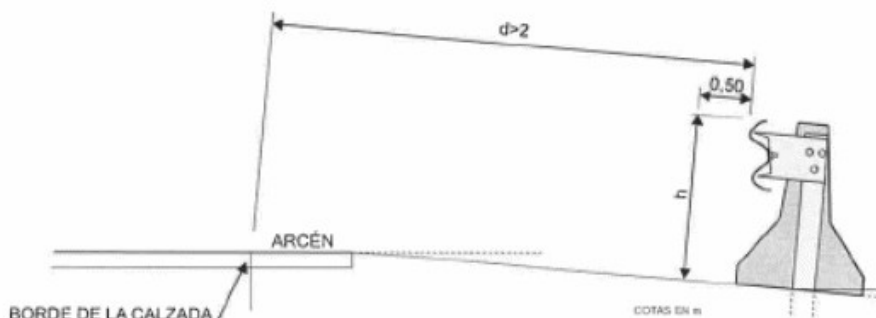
DISPOSICIÓN EN ALTURA DE LAS BARRERAS DE SEGURIDAD SITUADAS A MÁS DE 2m DEL BORDE DE LA CALZADA.
